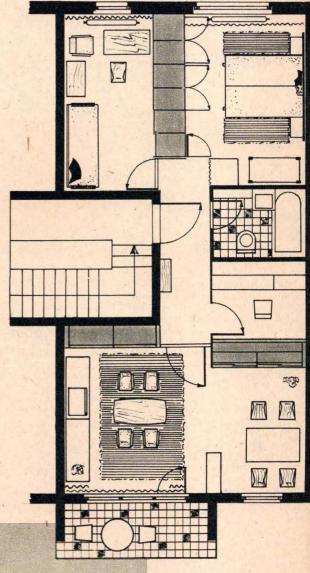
Grundriß einer 2¹/₂-Zimmer-Wohnung (getönte Flächen = Einbauschränke).
